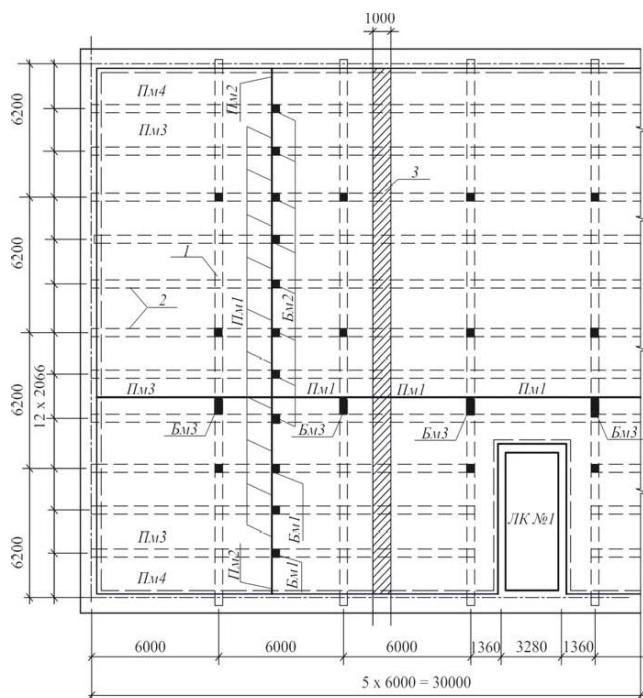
Конструктивная схема монолитного перекрытия:
